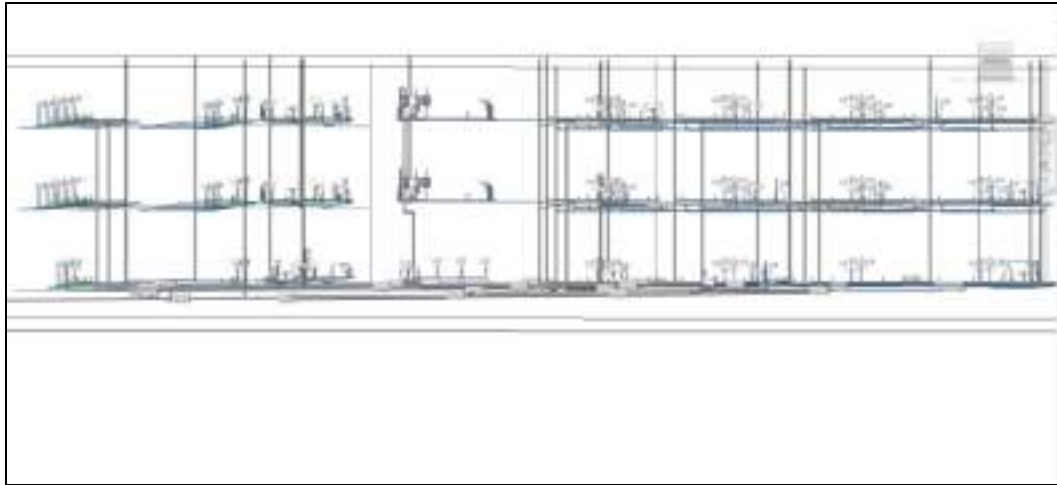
Modelado de Instalación hidrosanitaria del edificio de planta baja, primer y segundo piso (Vista en 3D)
